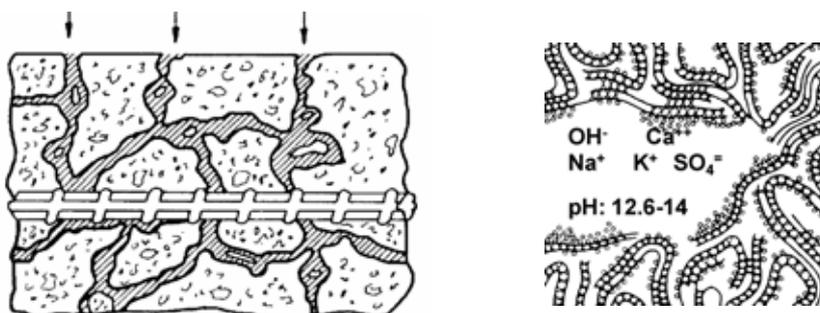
Armadura embebida en hormigón. Alcalinidad de la fase acuosa de los poros.
